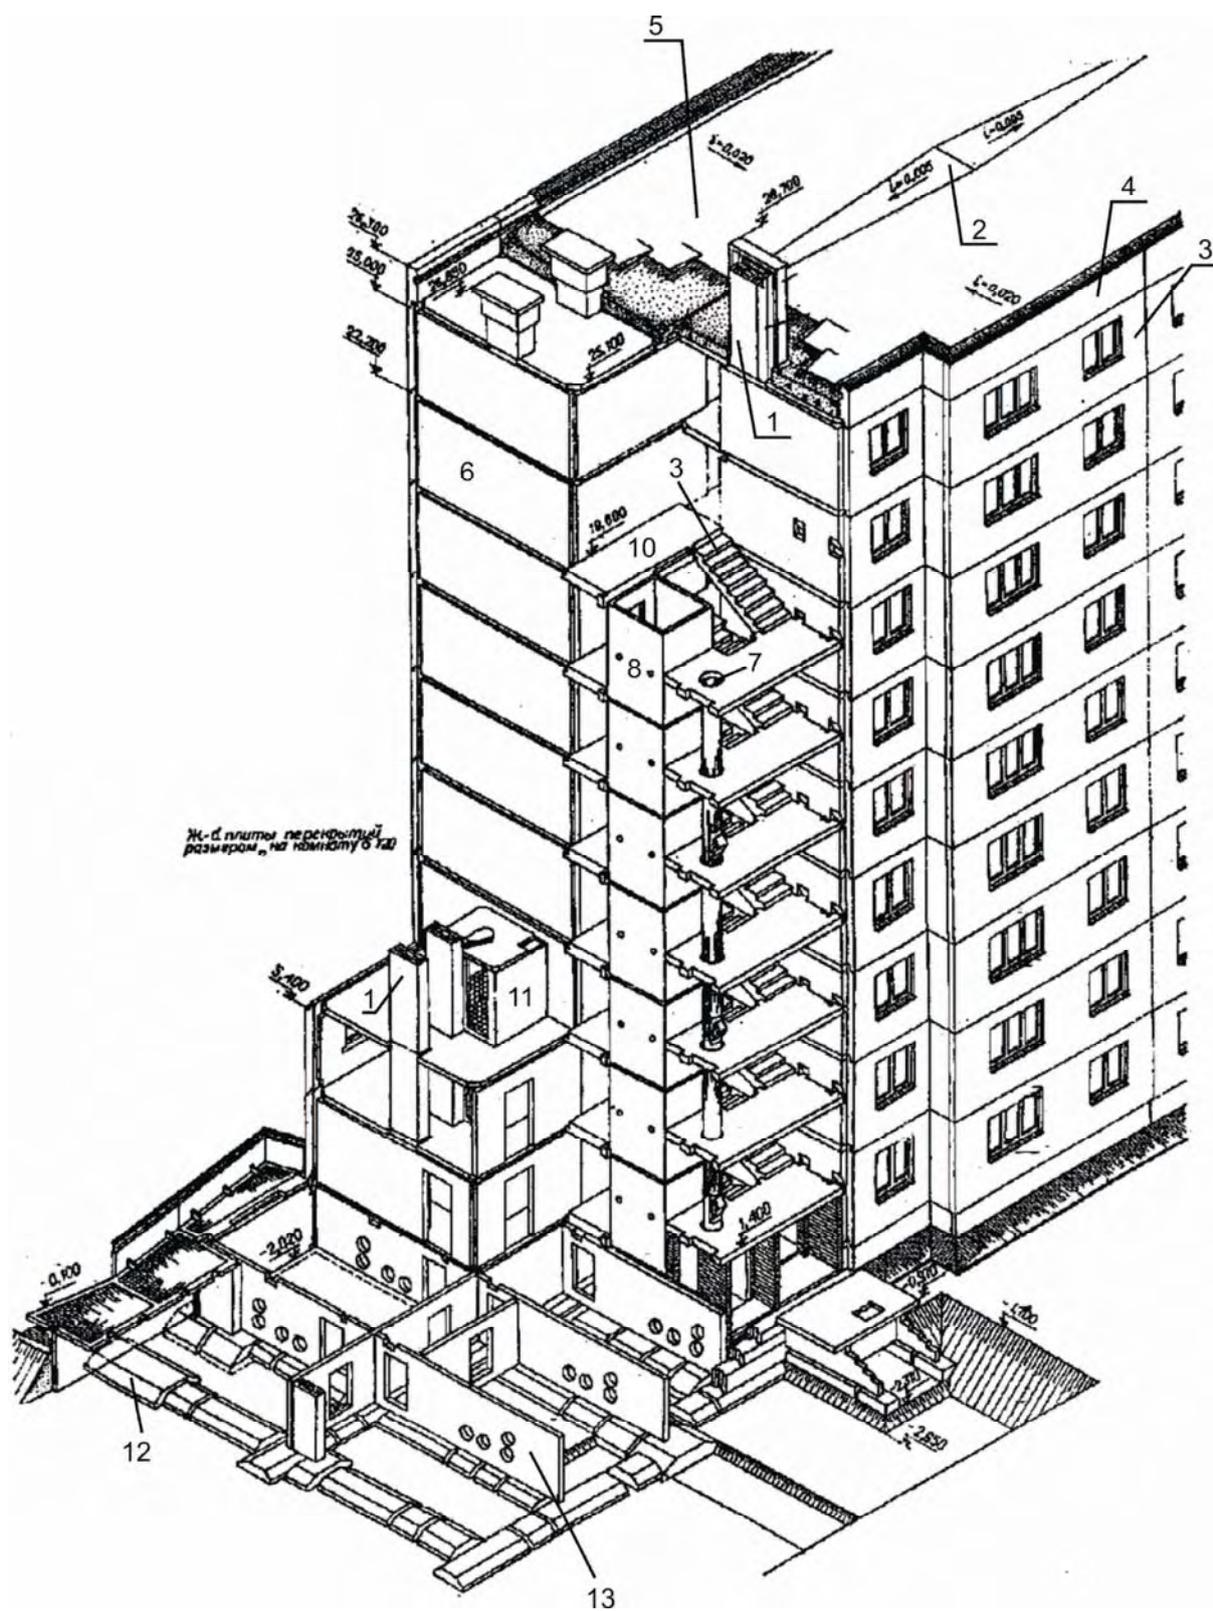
Пространственный разрез многоэтажного здания с малым шагом несущих стен и с панелями на две комнаты: 1 — вентиляционный блок; 2 — водораздел ендова; 3 — наружная стеновая панель; 4 — парапетная панель; 5 — совмещенная крыша с малоуклонной рубероидной кровлей по слою утеплителя; 6 — внутренняя стеновая панель; 7 — ствол мусоропровода; 8 — шахта пассажирского лифта; 9 — лестничный марш; 10 — лестничная этажная площадка; 11 — совмещенная сантехкабина; 12 — подушка фундамента; 13 — внутренняя стеновая панель технического подполья
